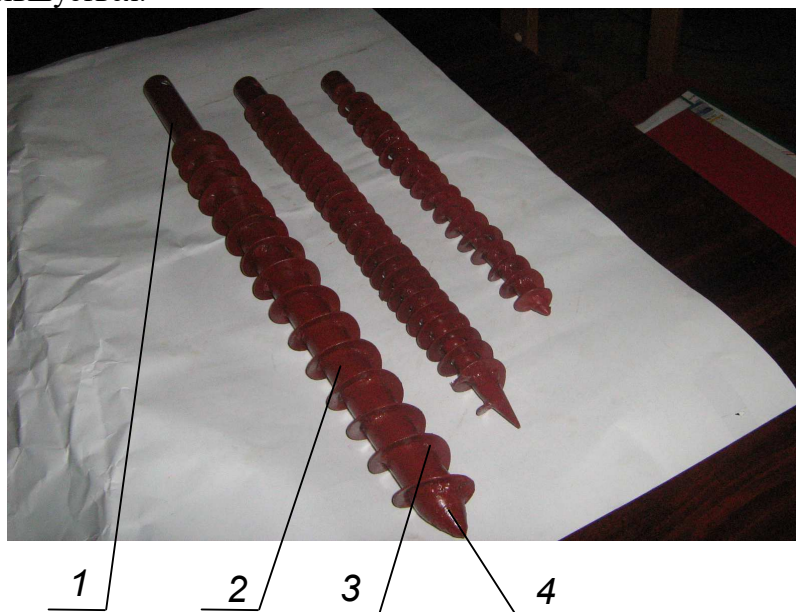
Експериментальні зразки гвинтових опор різних типорозмірів: 1 – корпус опори; 2 – циліндричний стержень; 3 – гвинтова спіраль шнека; 4 – кінцева насадка
